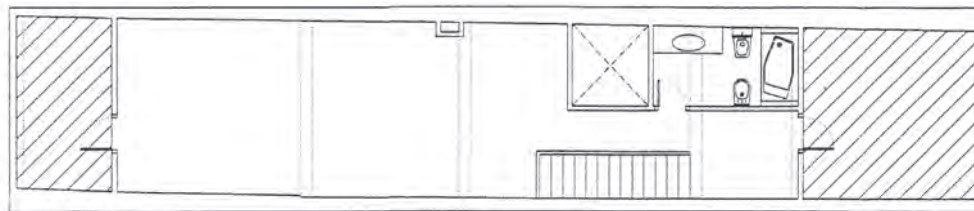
14. 1995 PLANTA PRIMERA REFORMADA
